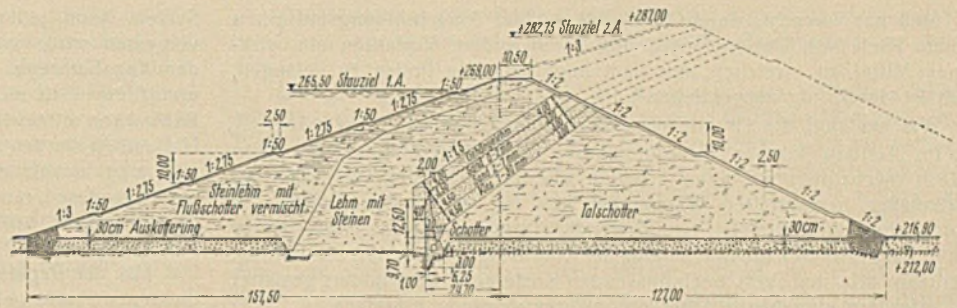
Dammquerschnitt der Rurtalsperre bei Schwammenauel mit Betonkern und schräger Stahldichtungswand aus Spundbohlen.
